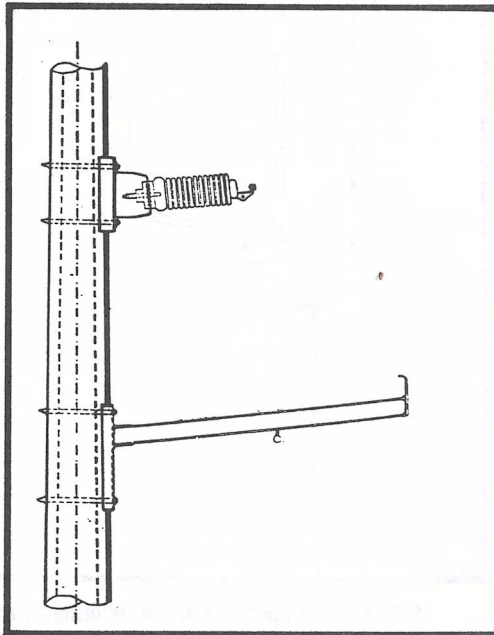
Posição e detalhe do braço metálico de proteção.
